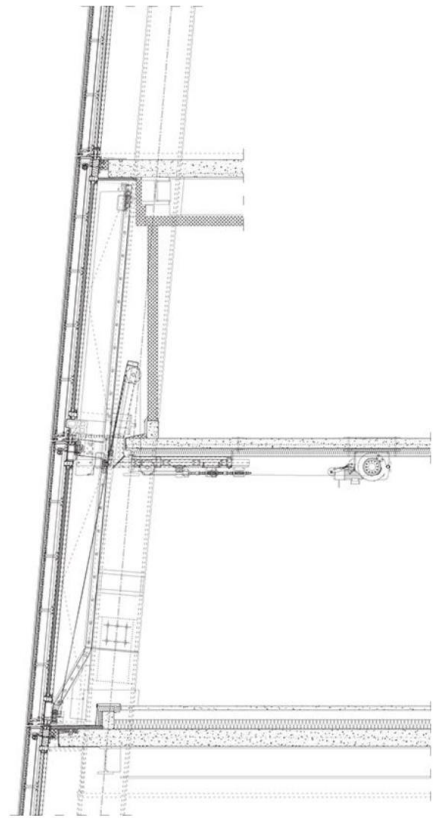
Detalle constructivo porta de cunas de limpeza do The Shard
